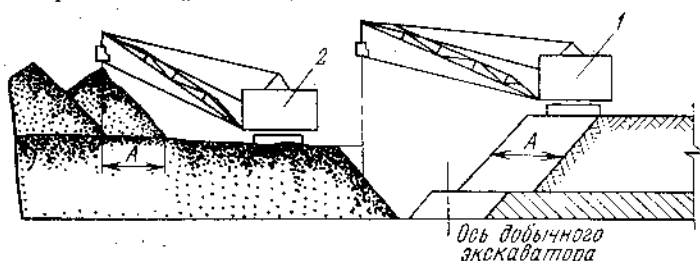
Схема бестранспортной системы разработки с кратной перевалкой пород
